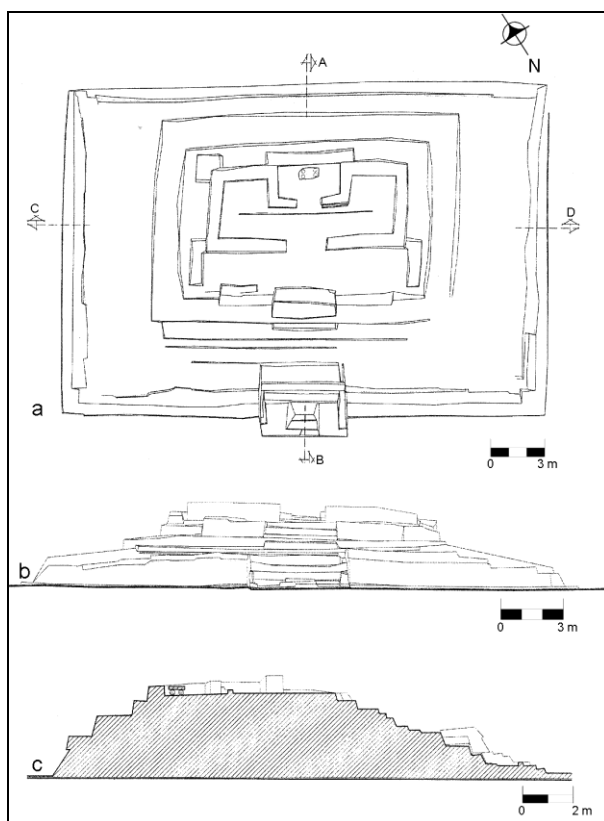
Estructura B-2, Grupo B. a: Planta; b: Fachada Suroeste; c: Corte A-B. Proyecto Arqueológico Isla Vieja, Tonalá, Chiapas. CONACULTA, INAH (Levantamiento O. Reyes).
